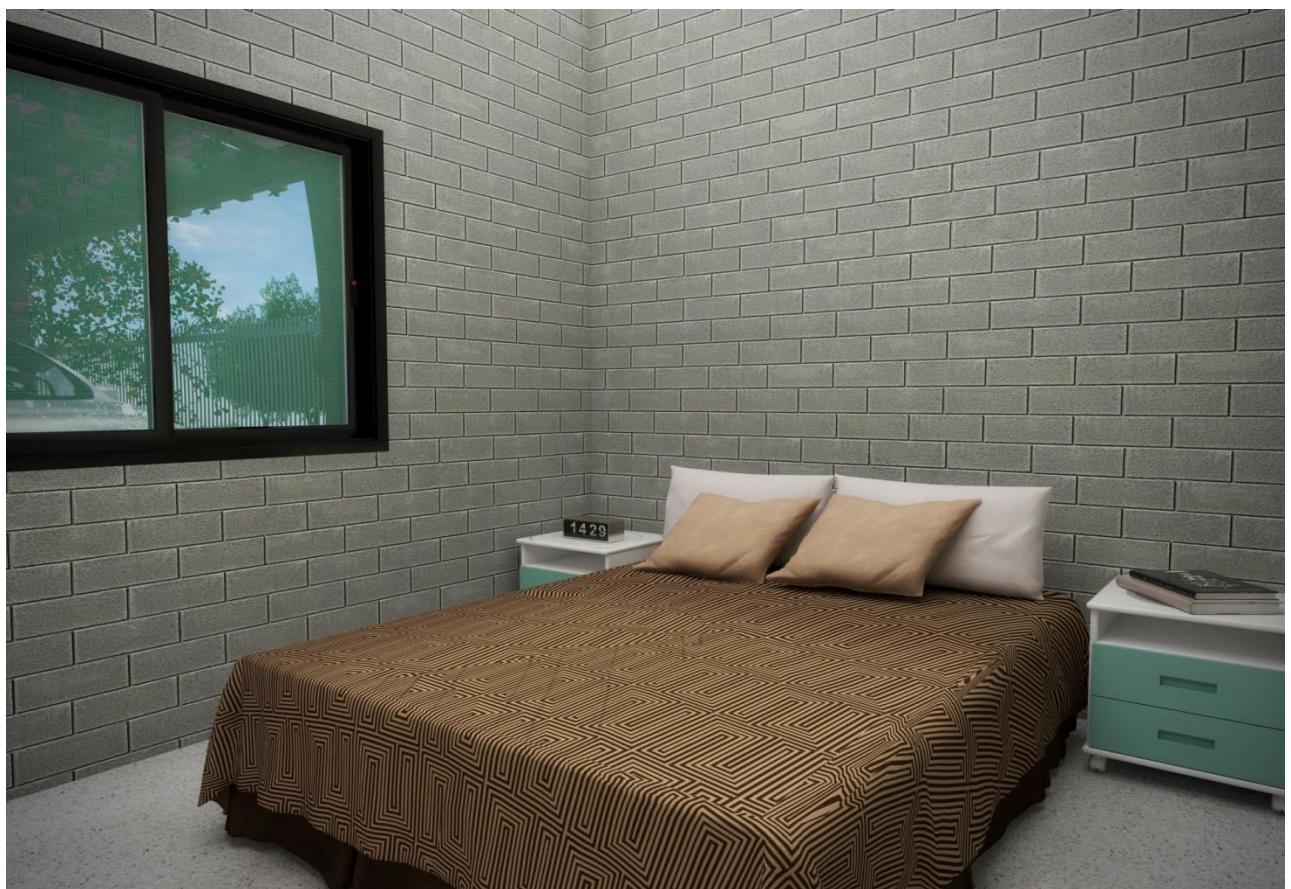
Perspectiva do Quarto – Planta tipo B. Fonte: Produzido pelo autor.
